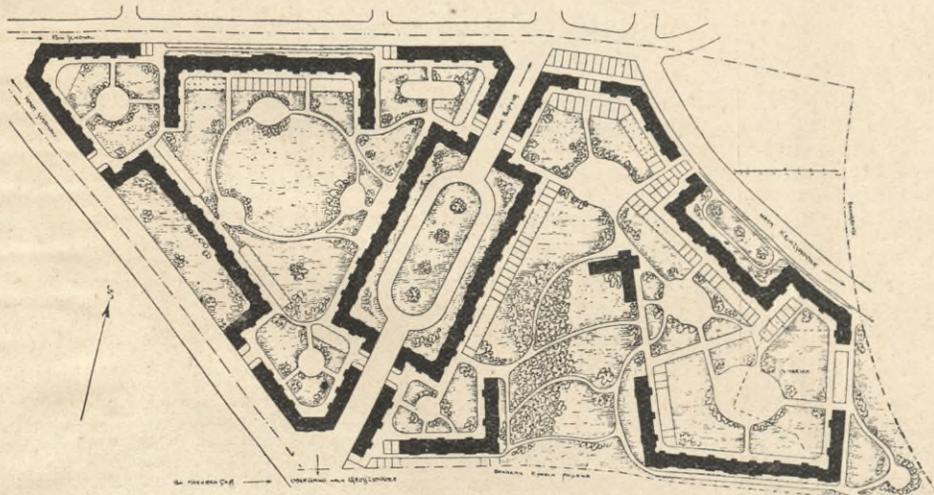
Stiftung für die Erbauung billiger Wohnungen in Leipzig, Kolonie Leipzig-Kleinzschocher Bebauung mit viergeschossigen Häusern
